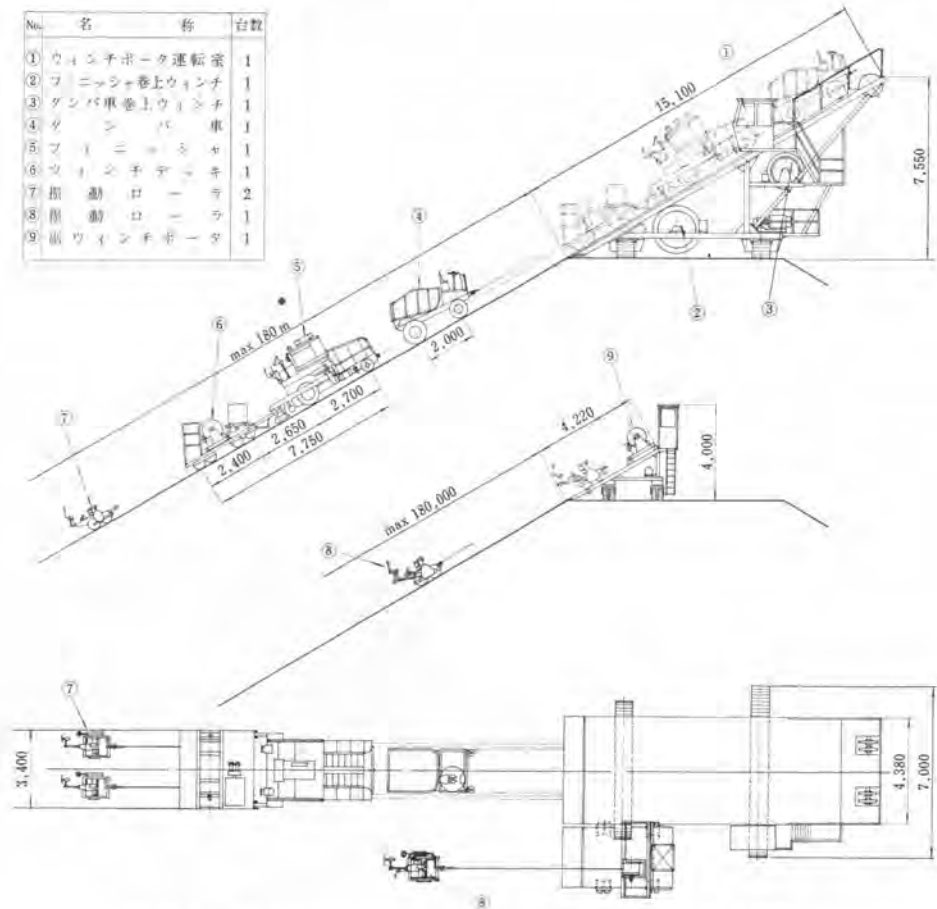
斜面用アスファルトコンクリート舗装機械配置図 (1号、2号、3号機)
